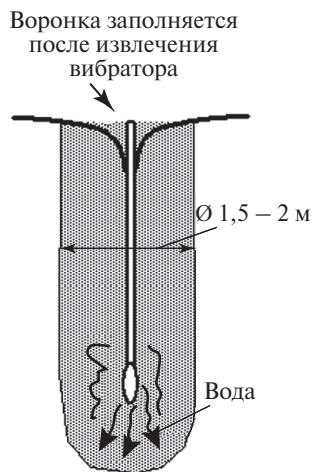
Схема глубинного гидровиброуплотнения песчаных грунтов
